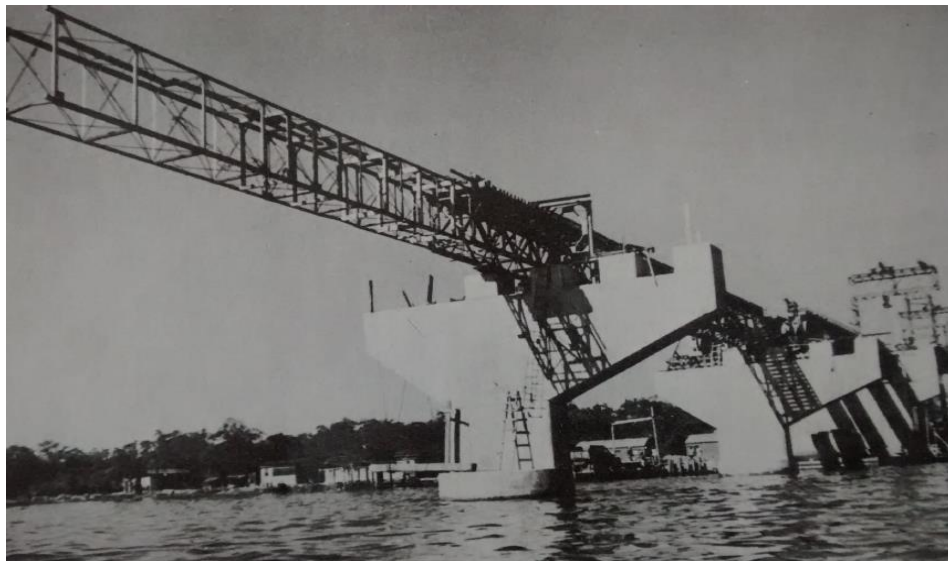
Colocación de la armadura longitudinal para el traslado de las vigas [1.2].
